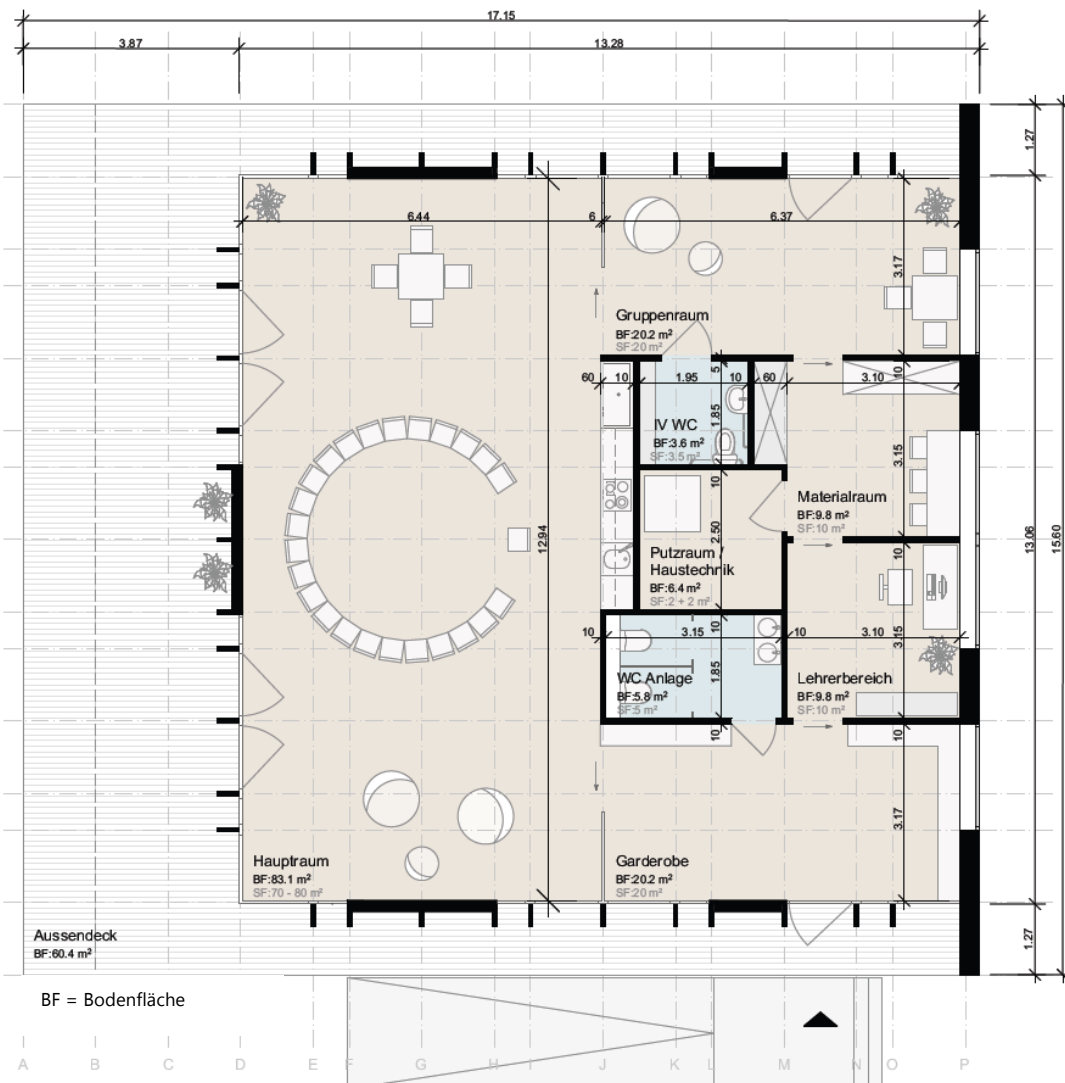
Grundriss Erdgeschoss Modulbau
